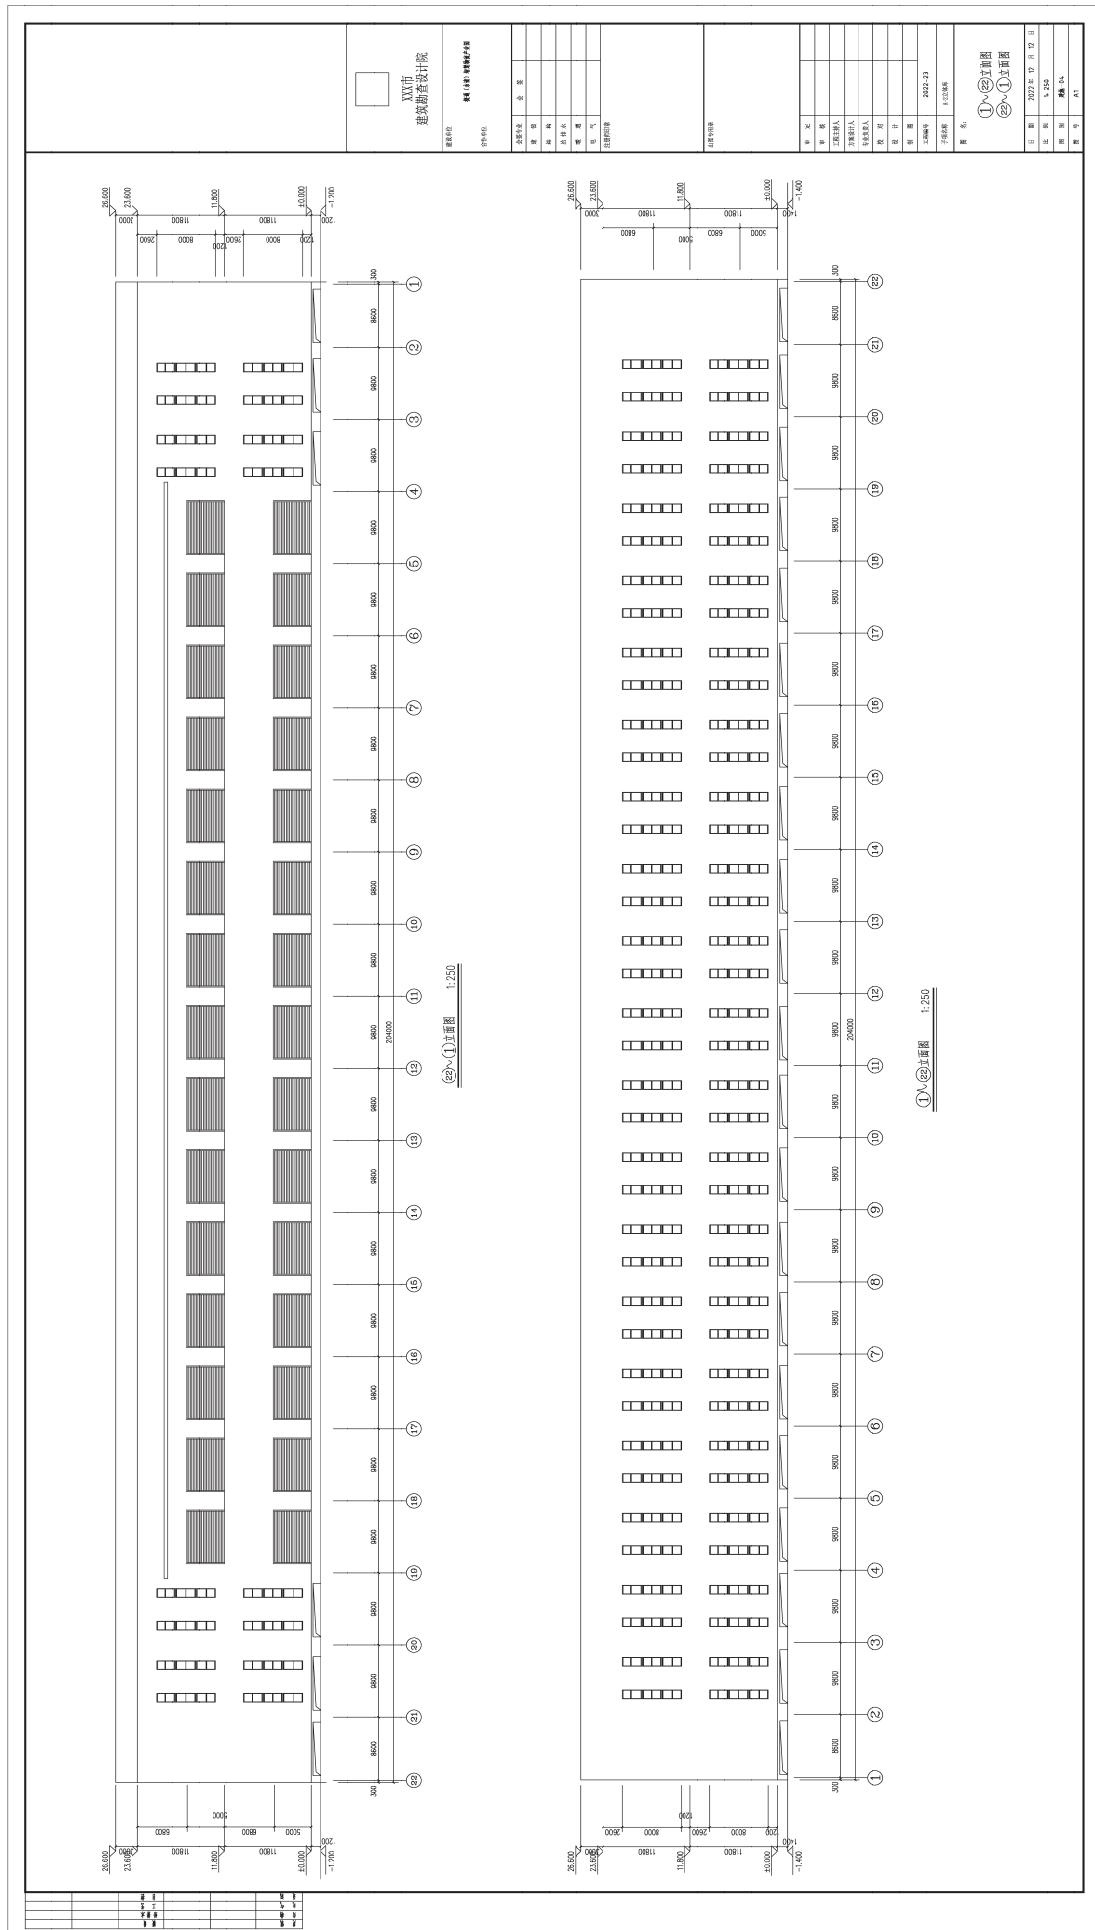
(a) A-1、A-2 仓库立面图 (长边)
